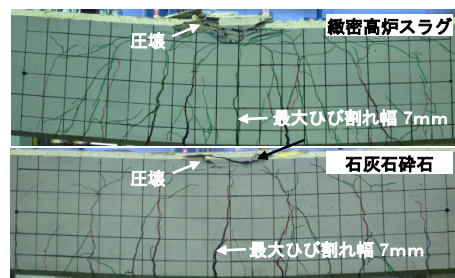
高強度 RC 梁試験体のひび割れ状況
